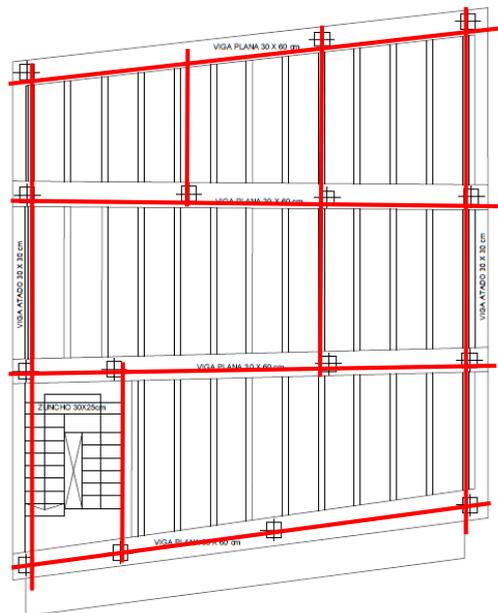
Estructura existente forjado 1. Fuente propia.
